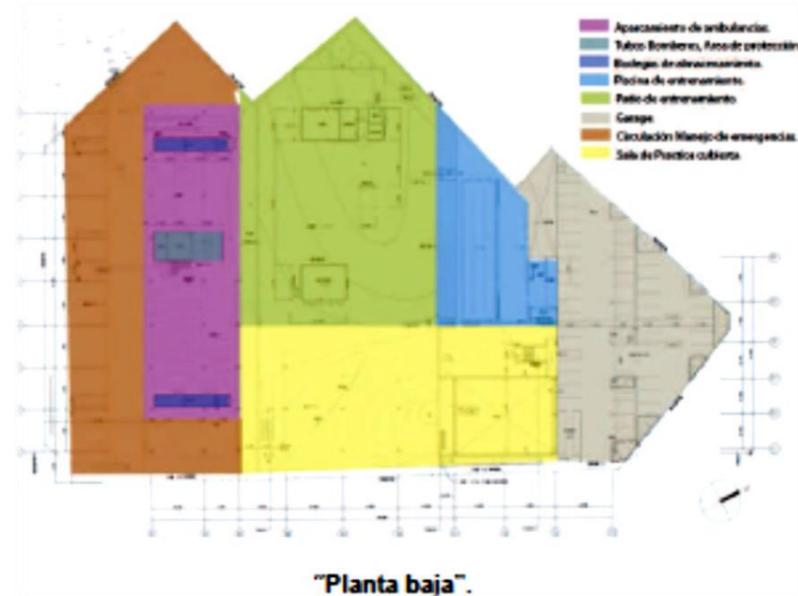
PLANTA BAJA<sup>50</sup> [IMAGEN# 10]
